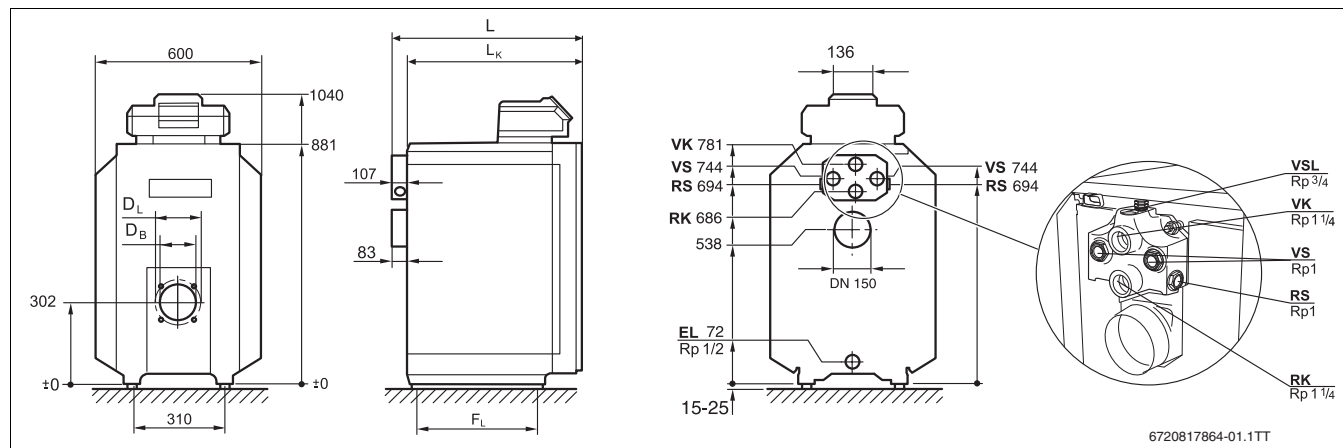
Conexiones y dimensiones (dimensiones en mm)
